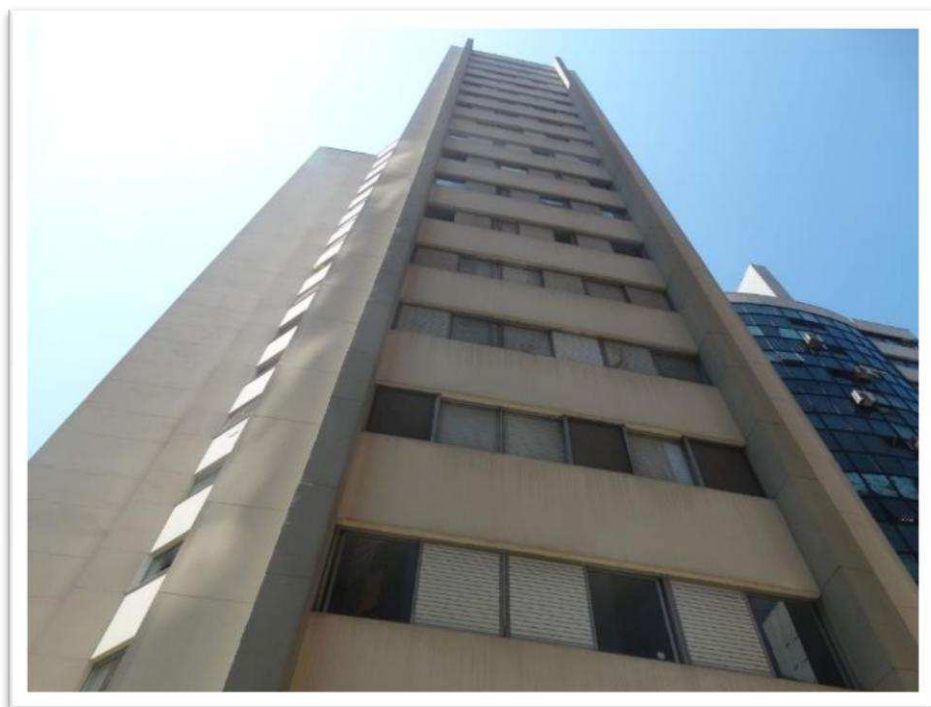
Vista parcial do Condomínio Edifício Via Colomba – Fachada lateral direita do edifício.
